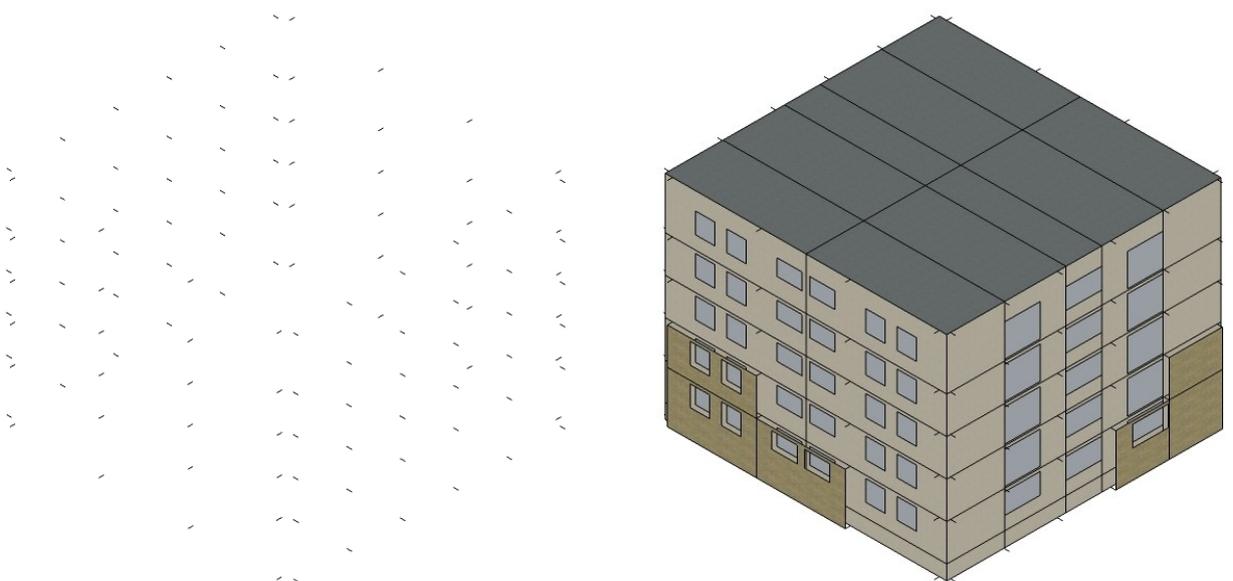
fixations ponctuelles (à gauche), panneaux fixés au bâtiment sans ossature avec des fixations ponctuelles (à droite)
